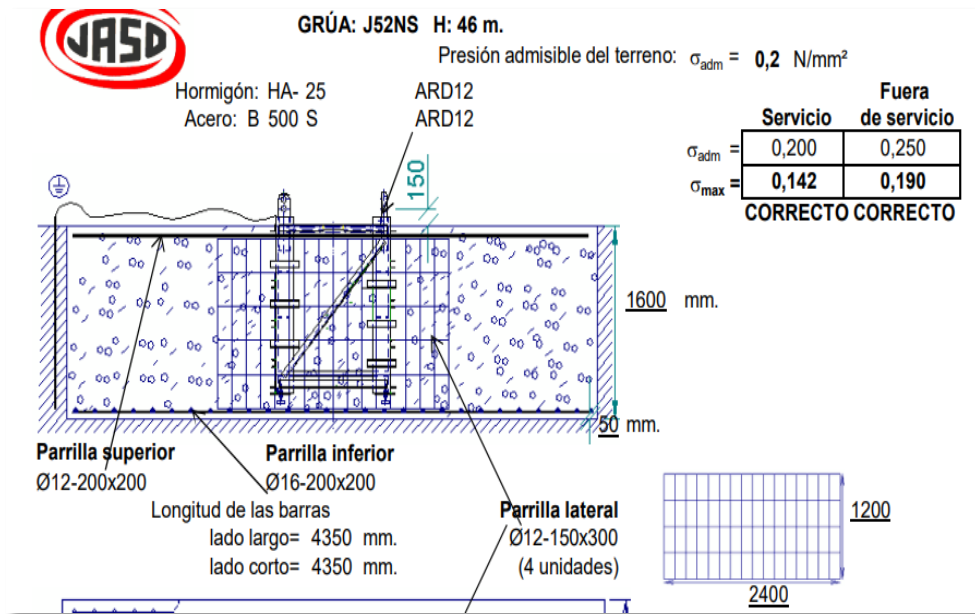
Detalle estructural de zapata (Fuente: Jasd, 2019)
